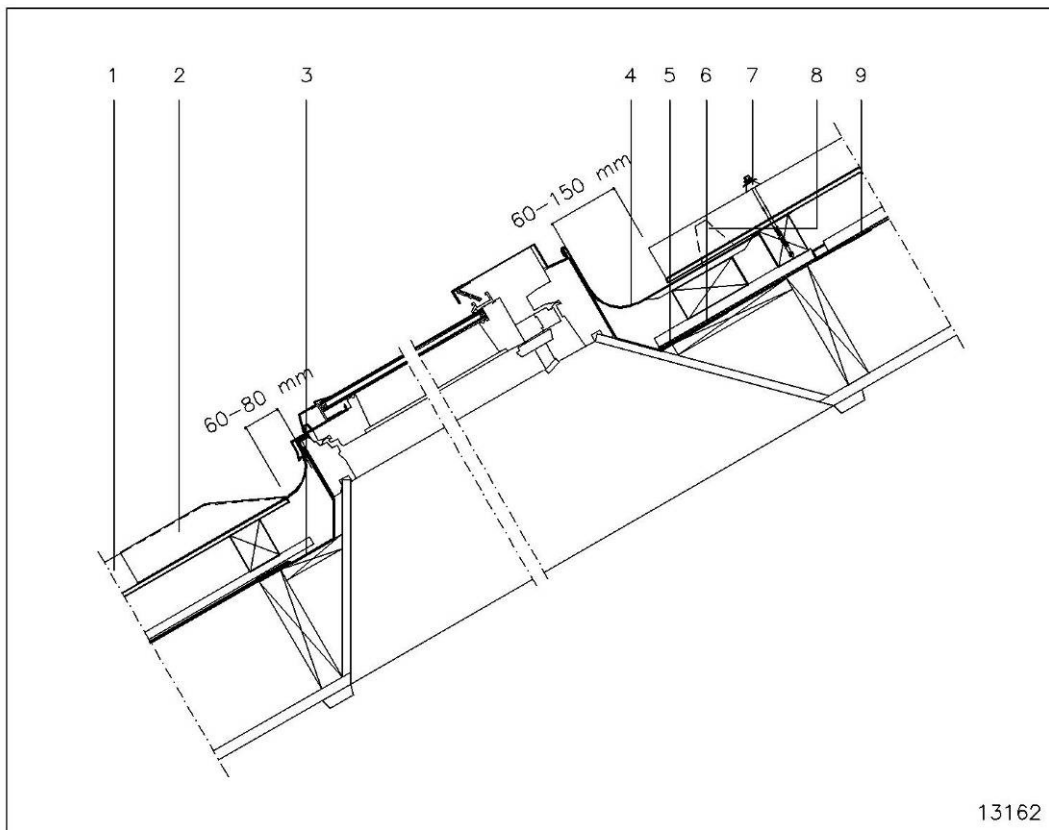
Installation d'une fenêtre de toit – finition supérieure et inférieure
